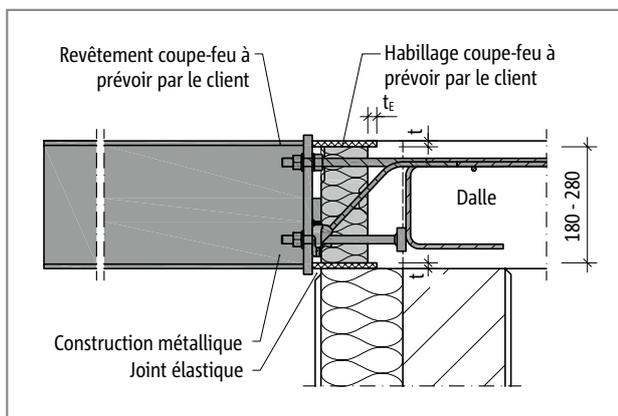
Schöck Isokorb® T type SK : Bardage de protection incendie sur site - T type SK, construction en acier avec revêtement de protection incendie ; coupe
